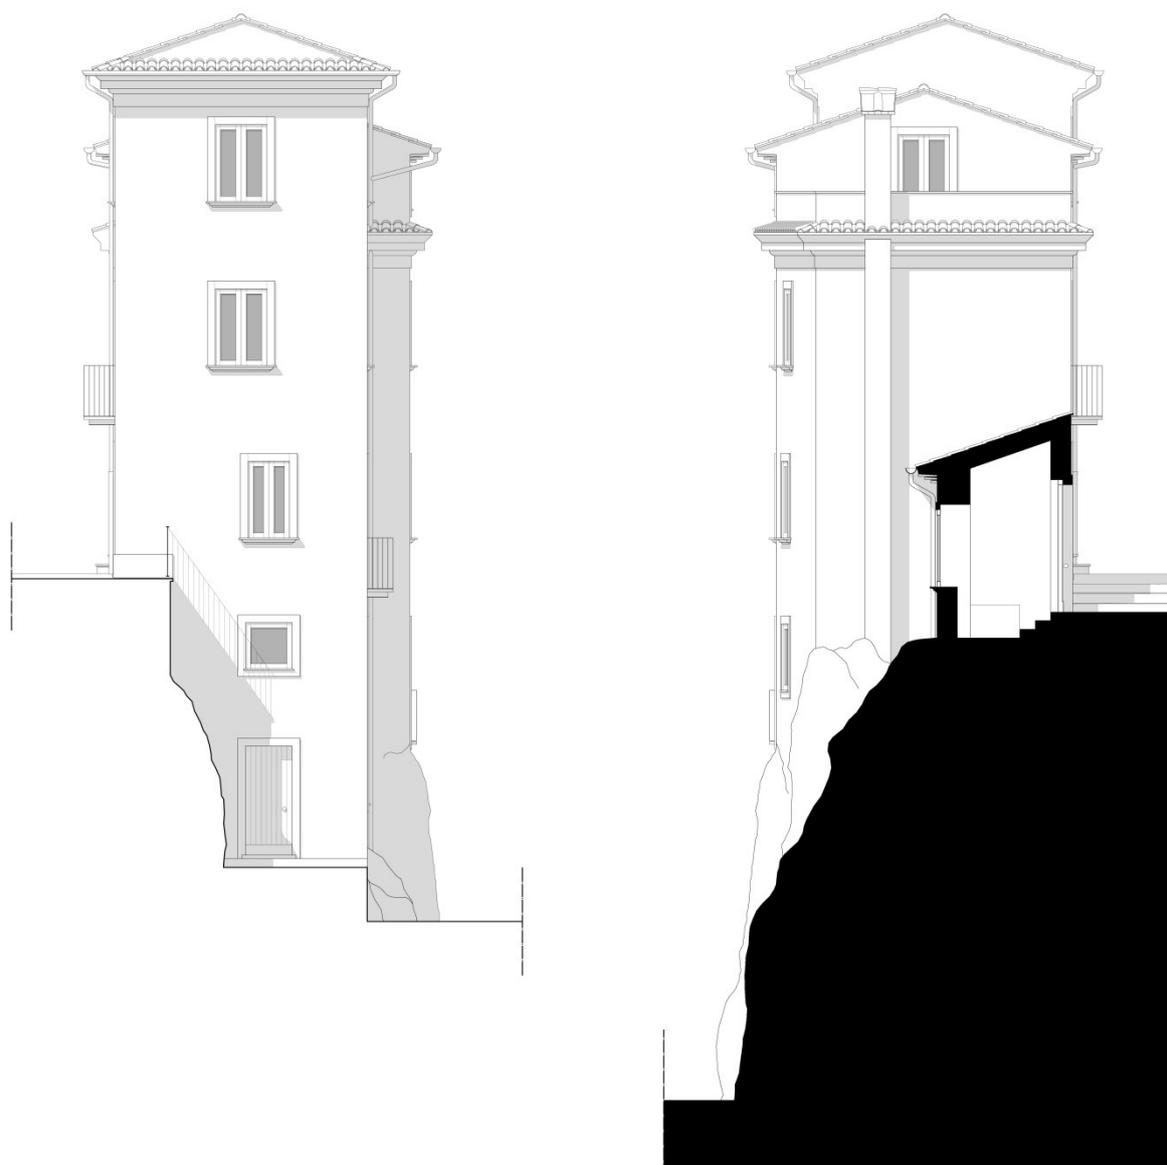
Prospetto Est e prospetto Ovest
